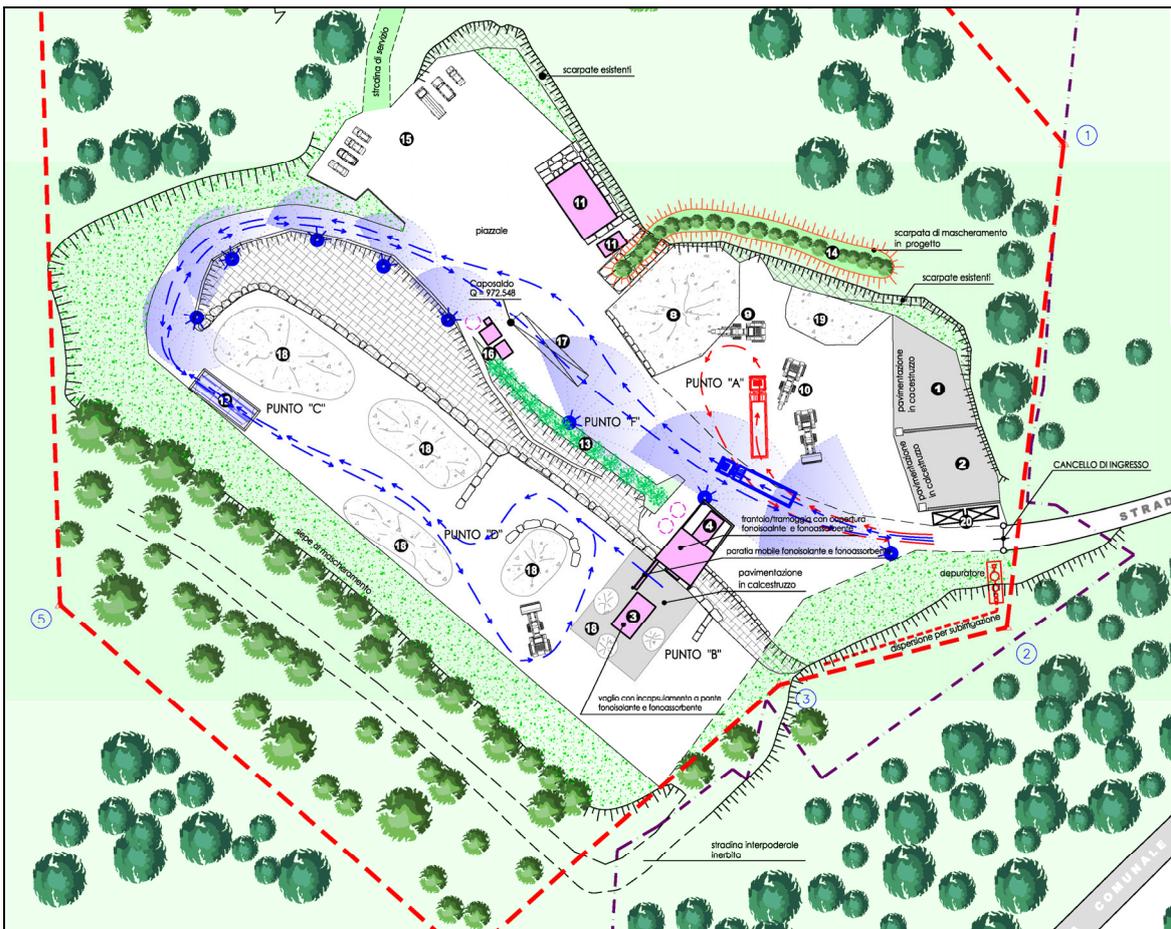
Planimetria dello stato autorizzato attuale dell'area di intervento
